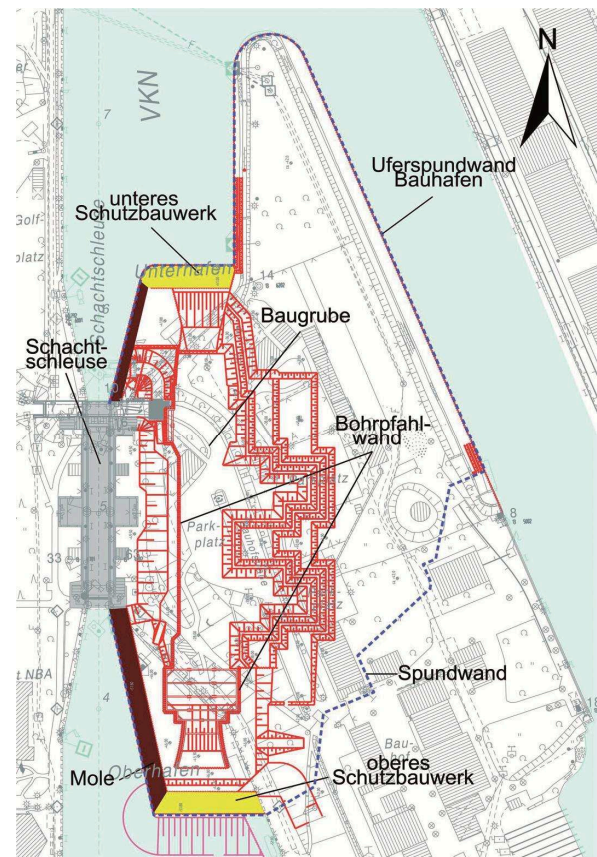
Lageplan der Baugrube mit Baugrubenumschließung
